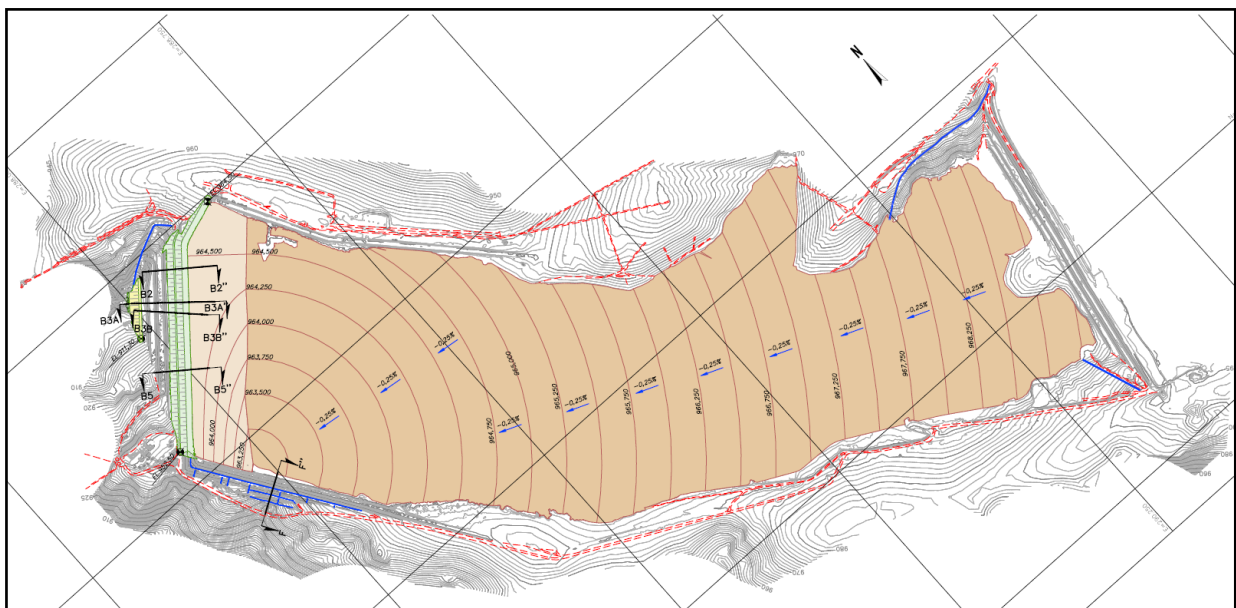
Arranjo geral do projeto de descaracterização da Barragem B5.
